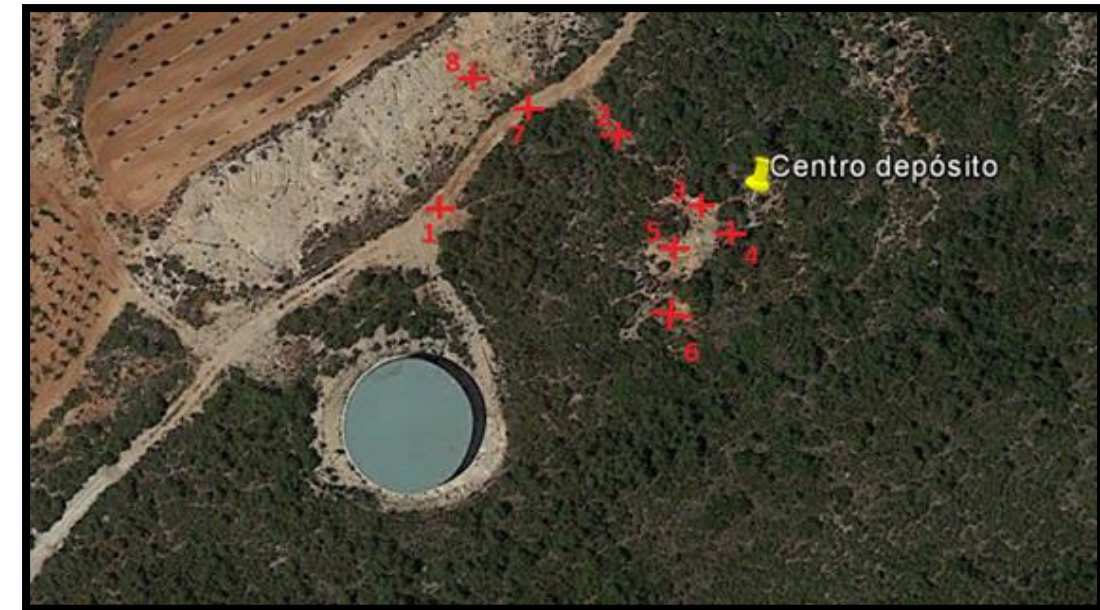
Plano en planta del lugar donde se han realizado las pruebas. (Fuente: Google Earth y elaboración propia).
